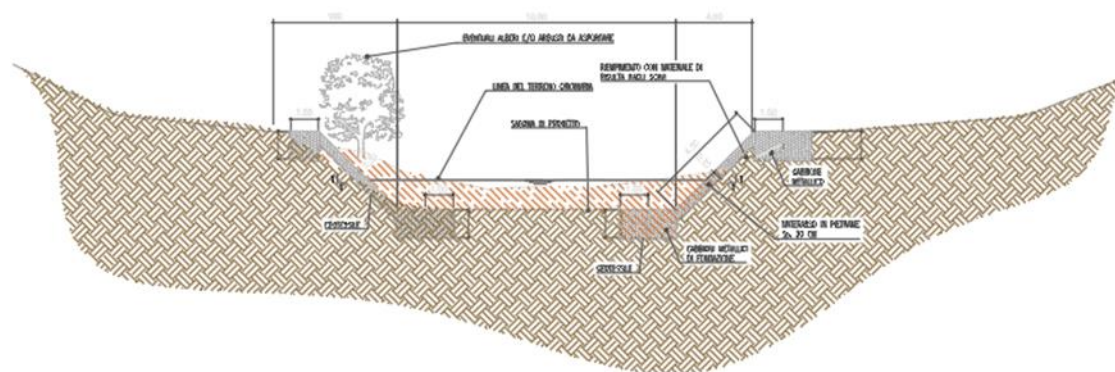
Seconda sezione tipo a seguito dell'intervento di riprofilatura e stabilizzazione delle sponde
